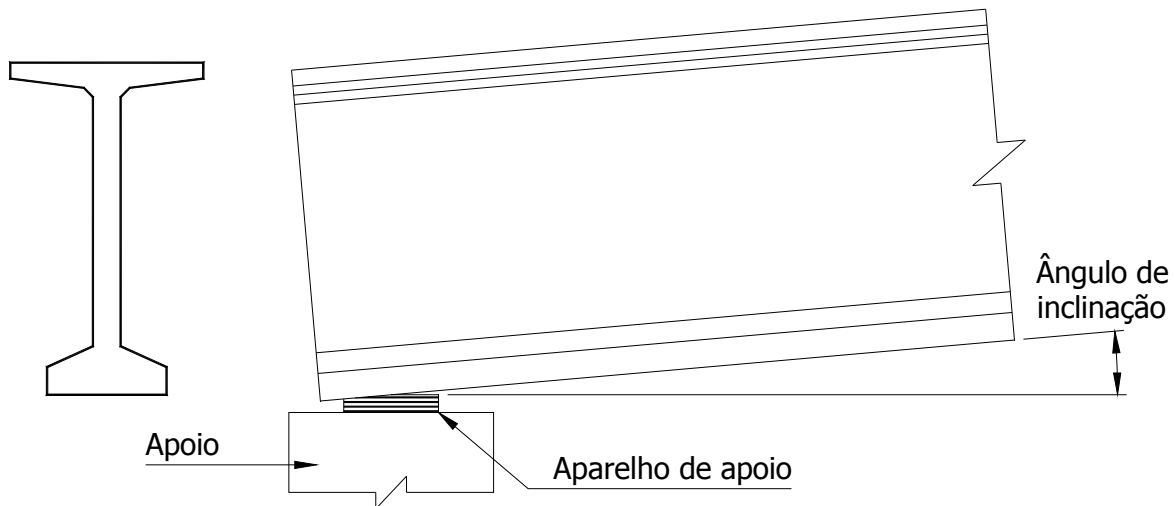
Representação da inclinação entre o aparelho de apoio e a viga
